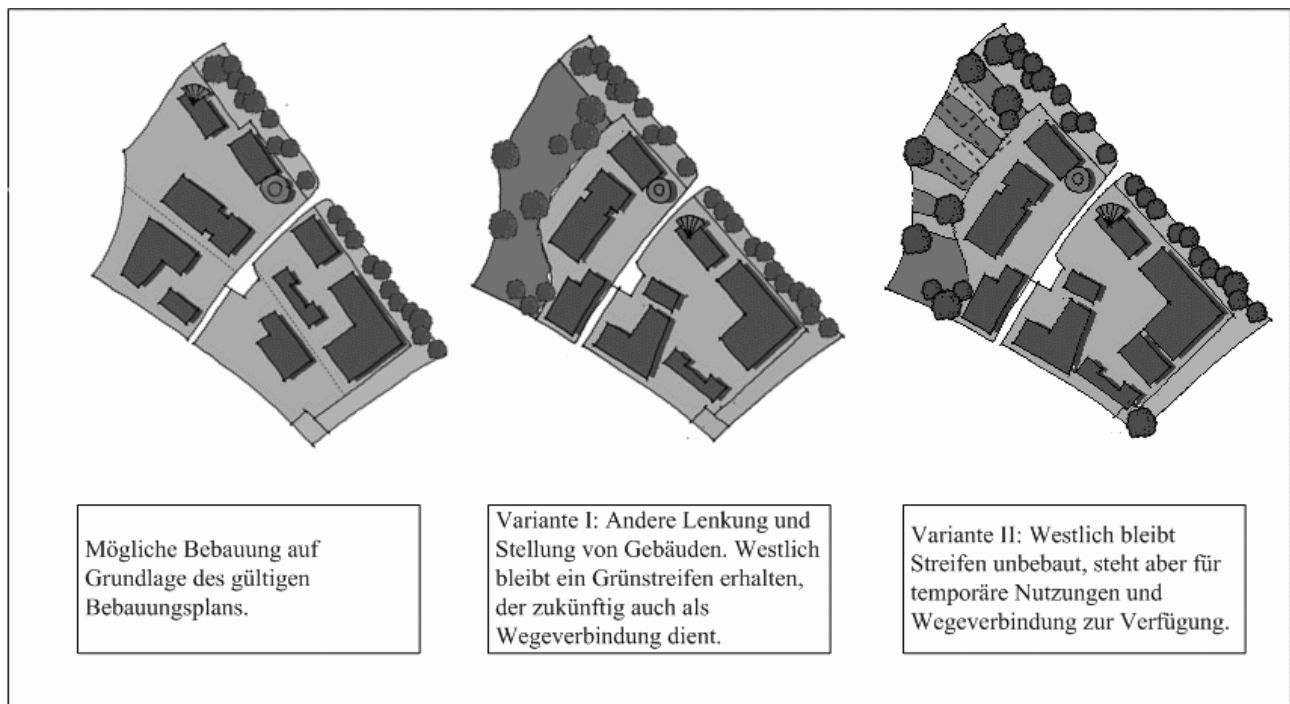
Planungsvarianten innerhalb eines Bebauungsplans
